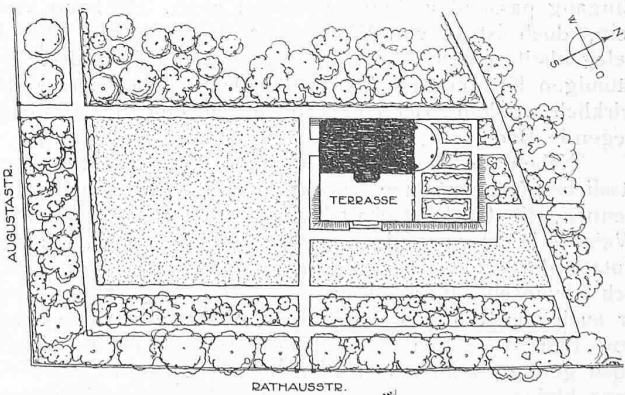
bis 9. Haus Gugenheim. — Grundrisse 1:400, Lageplan 1:1000.
